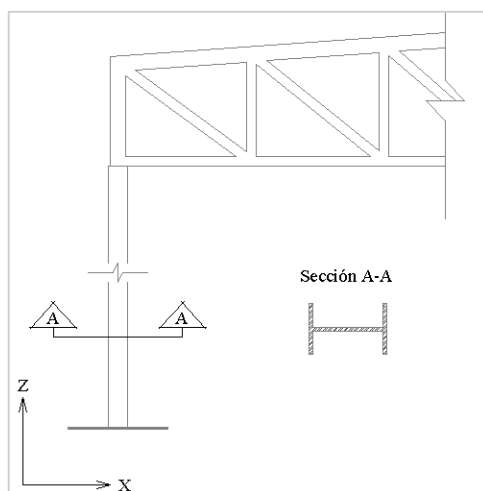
3. Posición de eje fuerte en columnas para galpón metálico.
